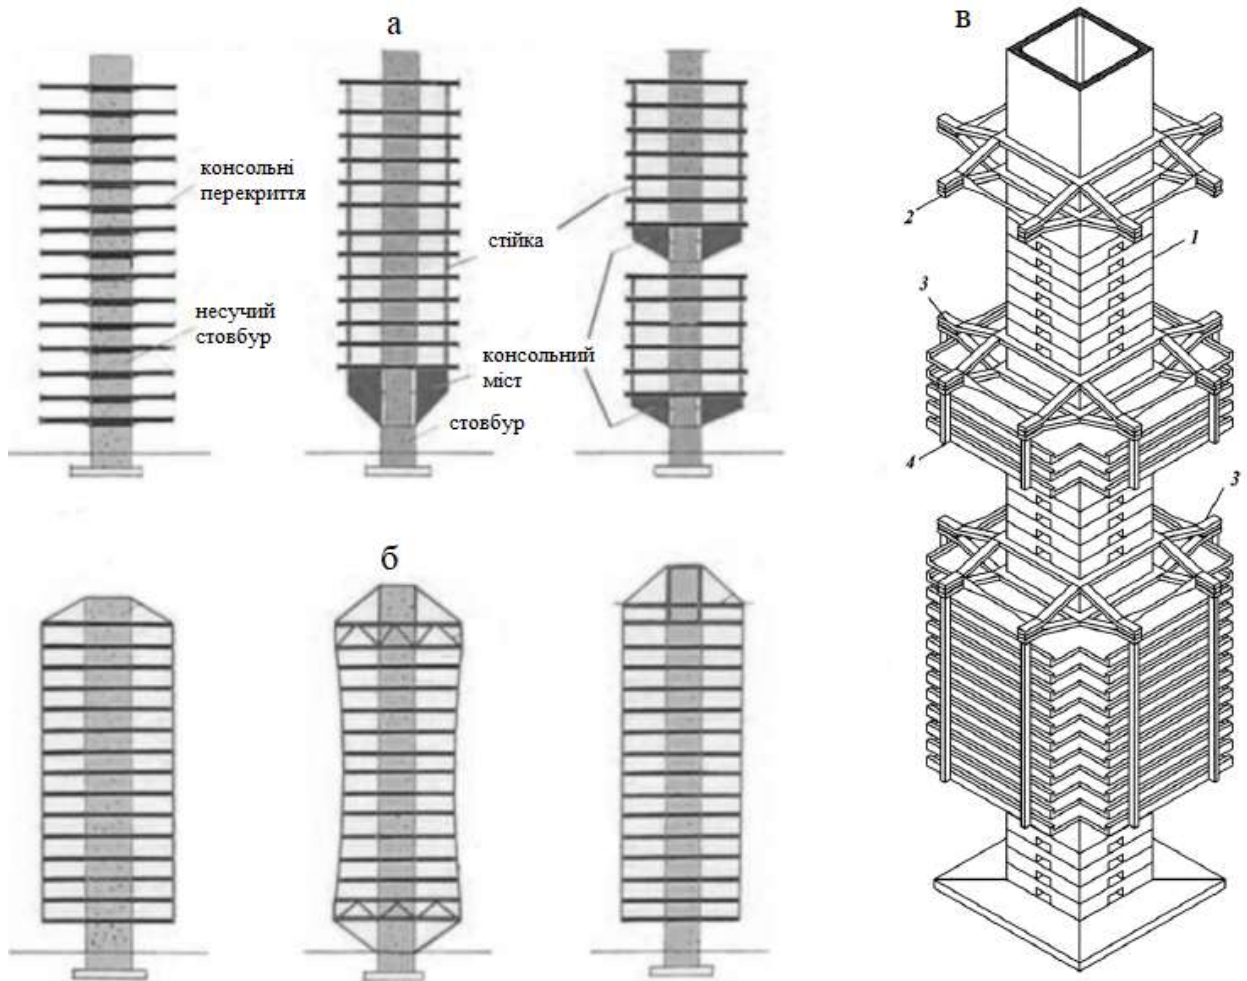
Варіанти стовбурної конструктивної системи: а – консольні системи; б – підвісні системи; в – будівля з перекриттями, підвішеними до консольних ростверків; 1 – стовбур; 2 – консольний ростверк; 3 – попередньо напружені залізобетонні балки; 4 – попередньо напружена залізобетонна підвіска
